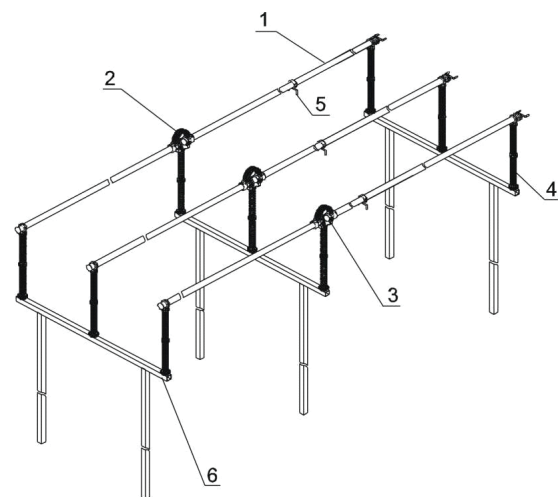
Принципиальная схема конструкции ЖО: 1 – трубчатая шина; 2 – токовый компенсатор; 3 – шинодержатель; 4 – опорный изолятор; 5 – замок; 6 – опорная рама.
